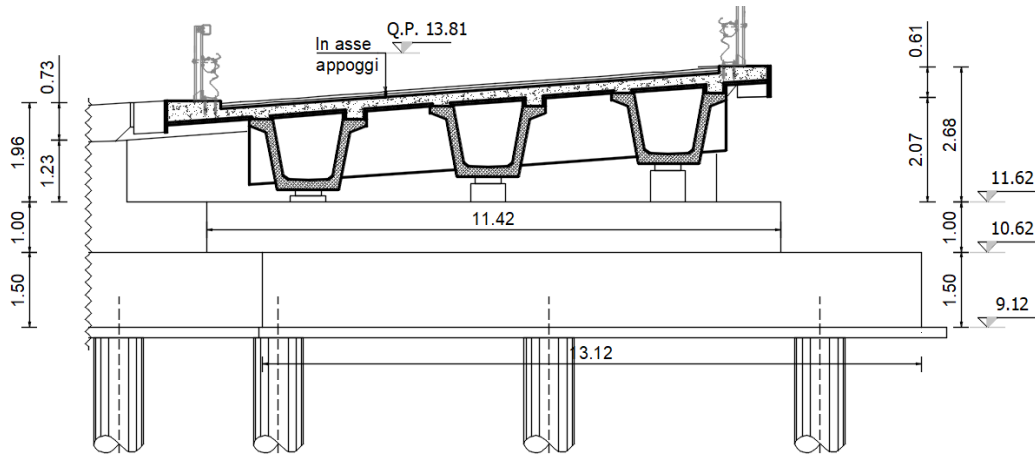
Prospetto spalla "SA" lato Asse Principale Direzione Nord
